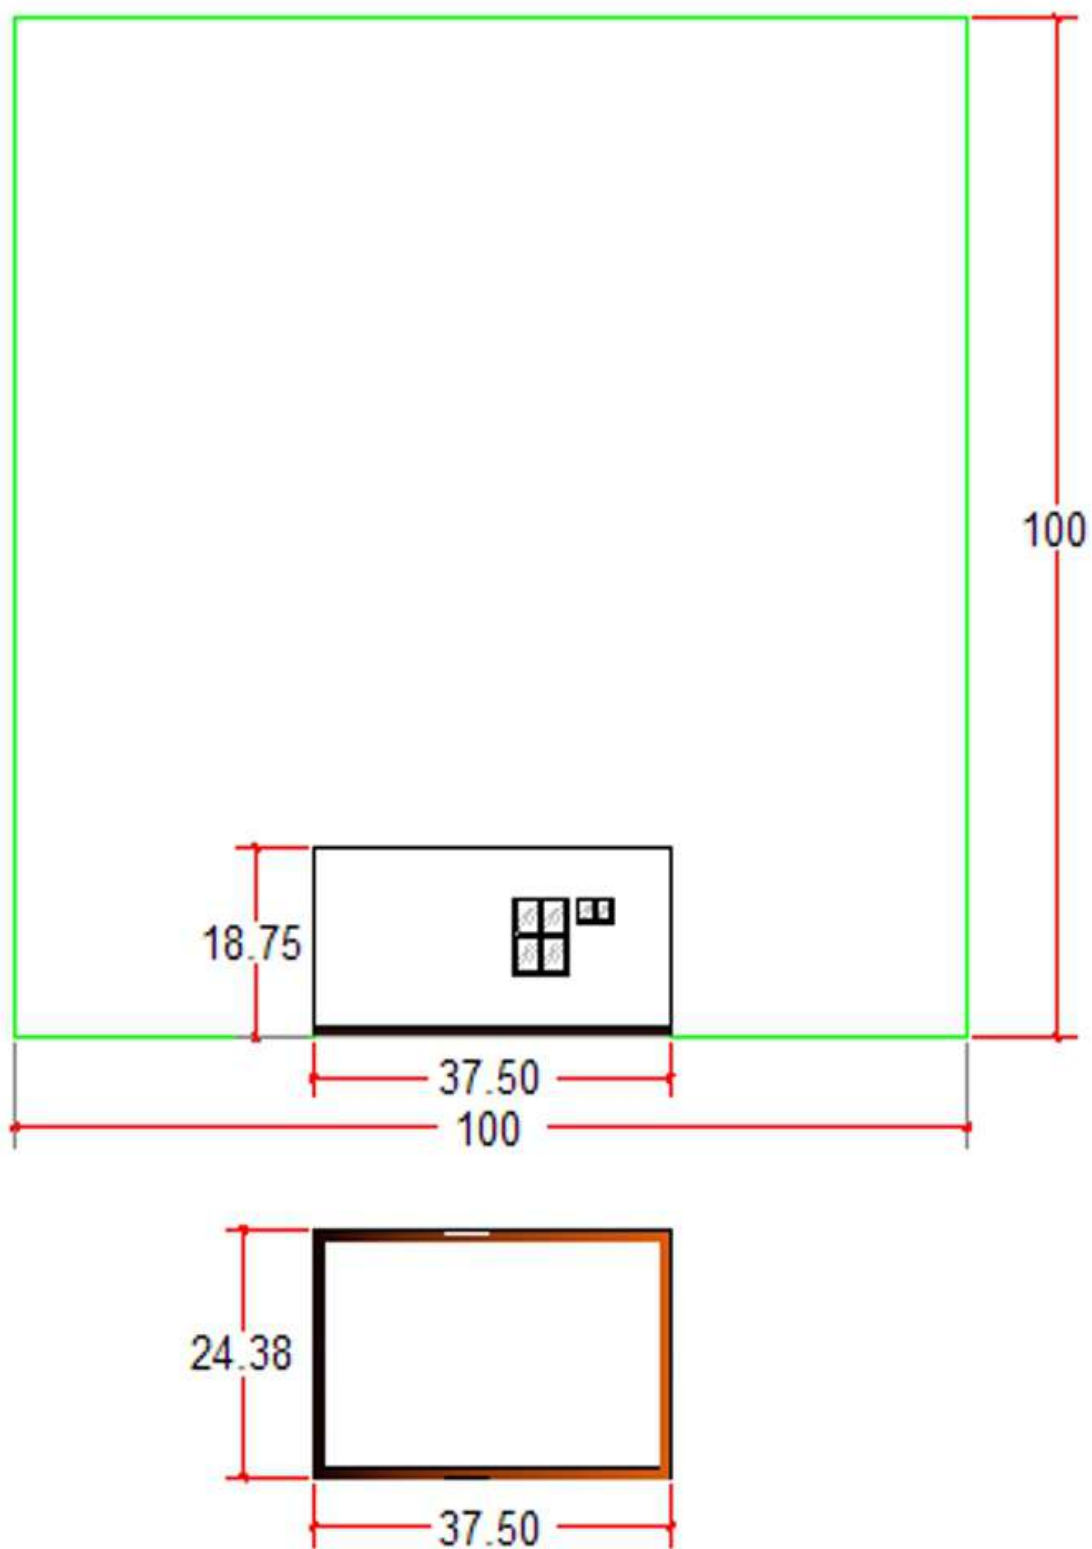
Dimensiones en centímetros de: Secciones transversales del modelo de CEC escalado a 1:16 en la cámara de ensayos y planta del modelo de CEC.
